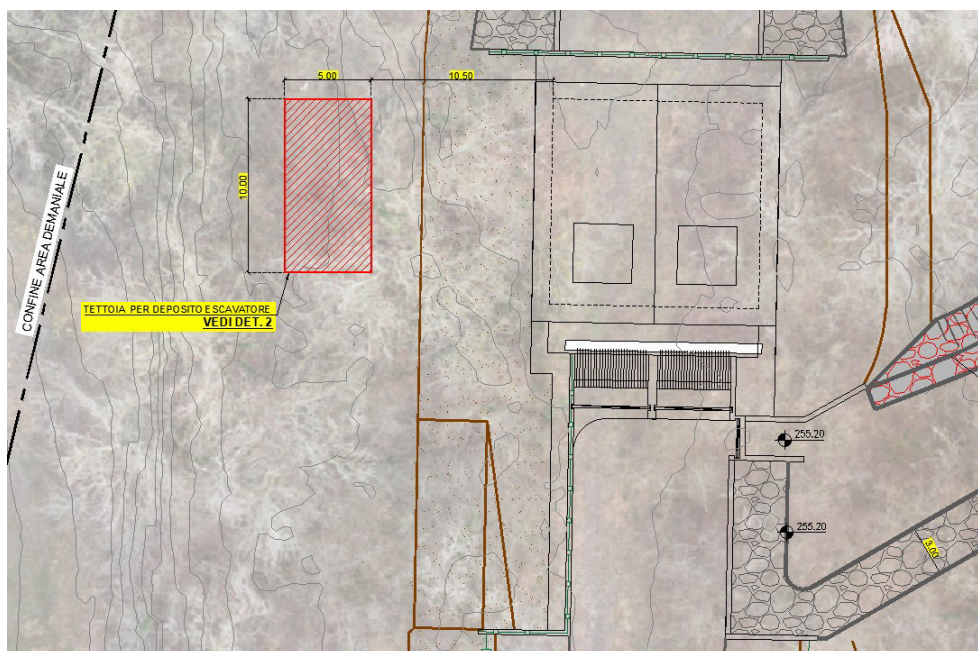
Area di installazione della tettoia per il deposito dell'escavatore
